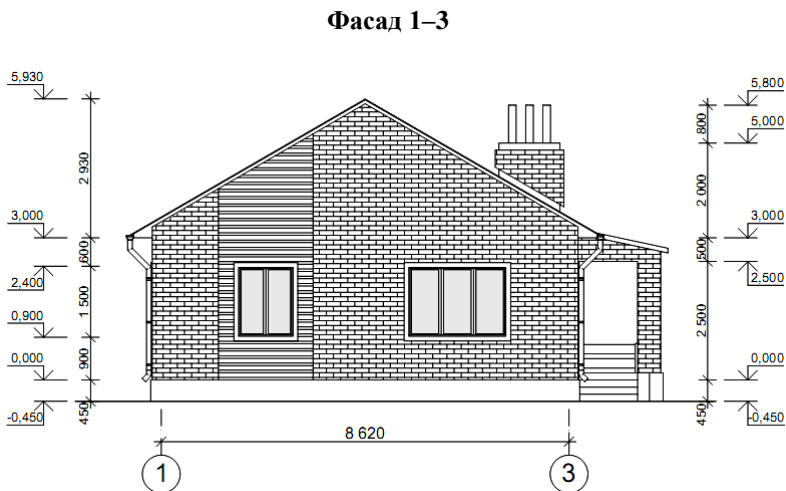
Пример оформления фасада малоэтажного жилого дома
